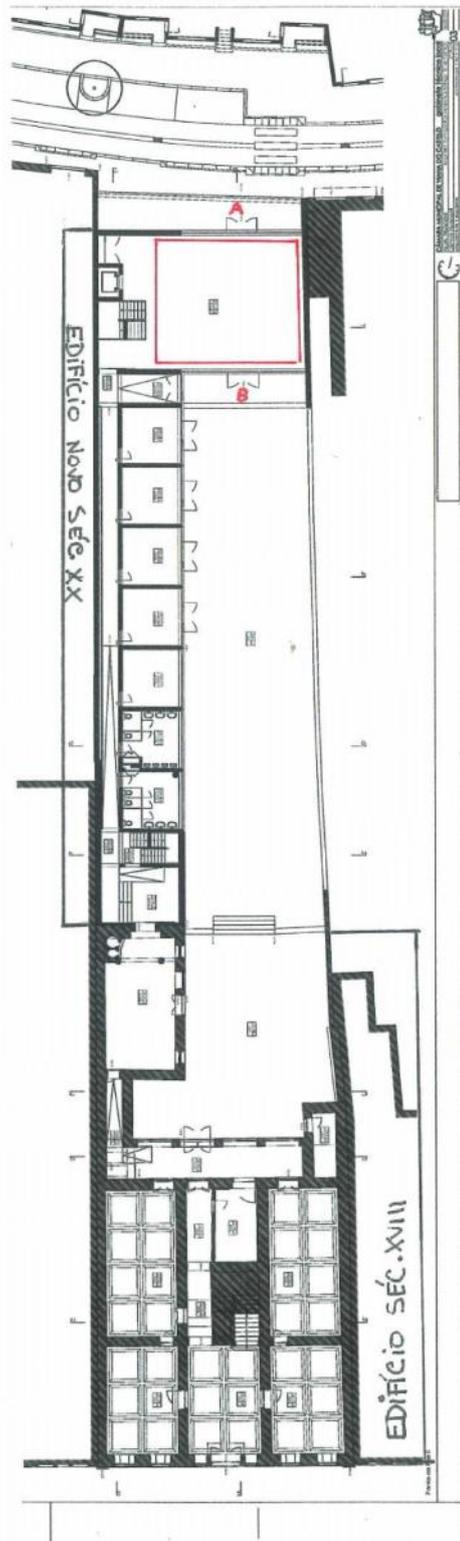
Planta galeria Museu (Fonte: acervo MAD)
